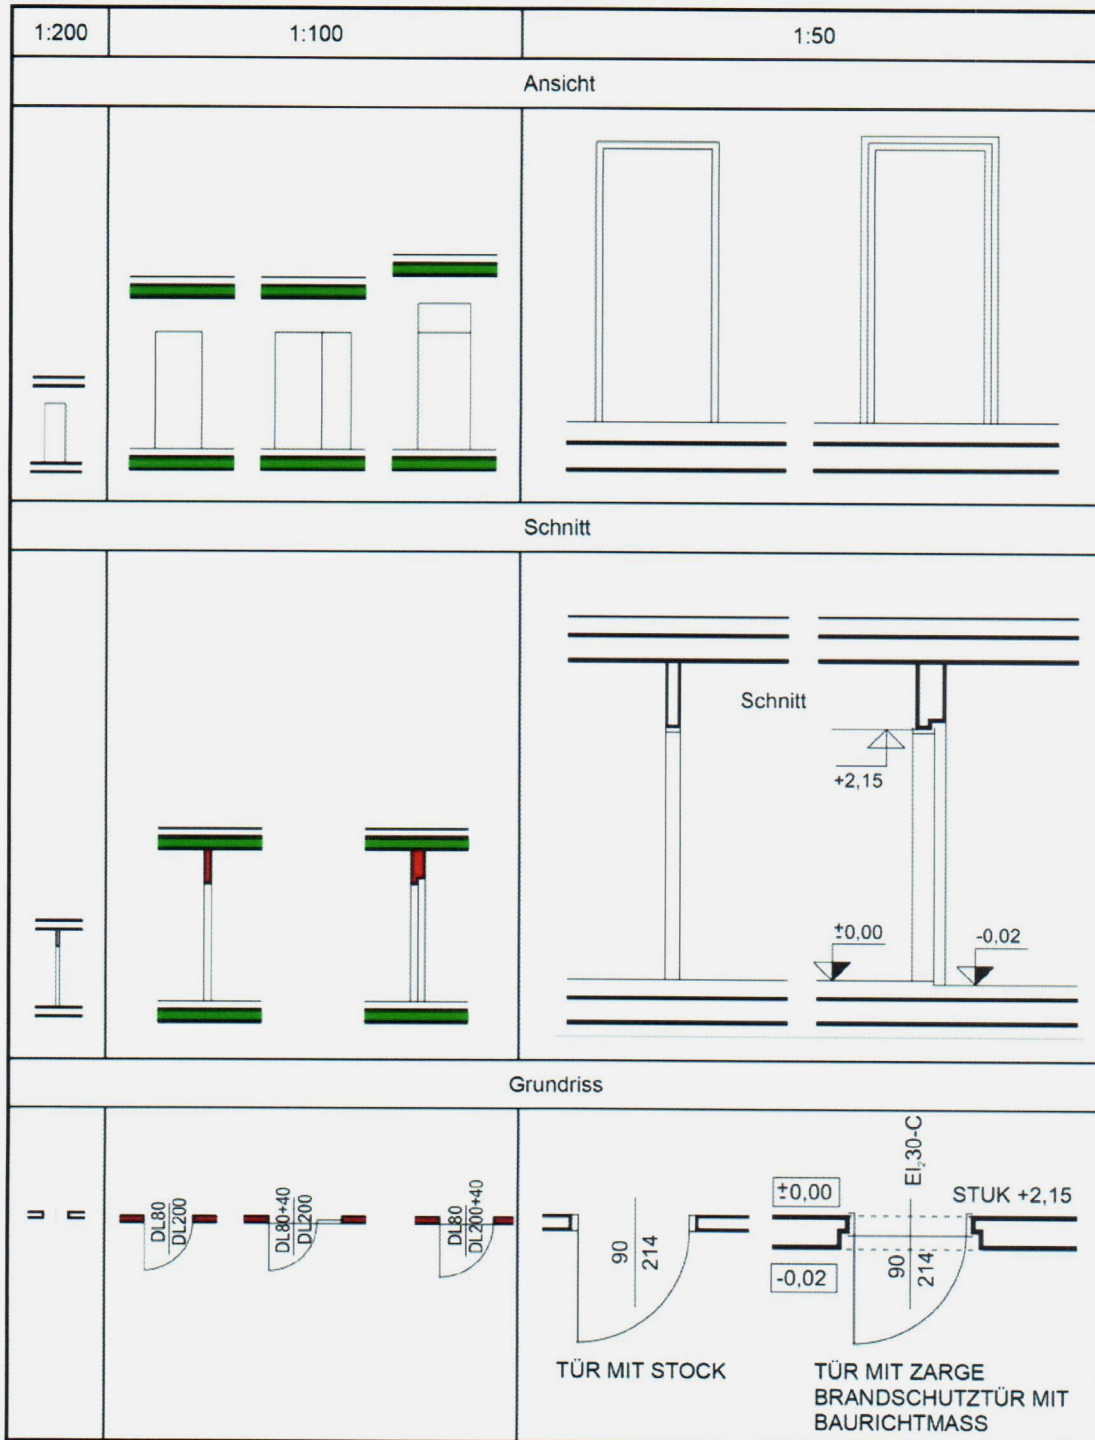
Beispiel für die Darstellung von Türen in Grundriss, Ansicht und Schnitt
